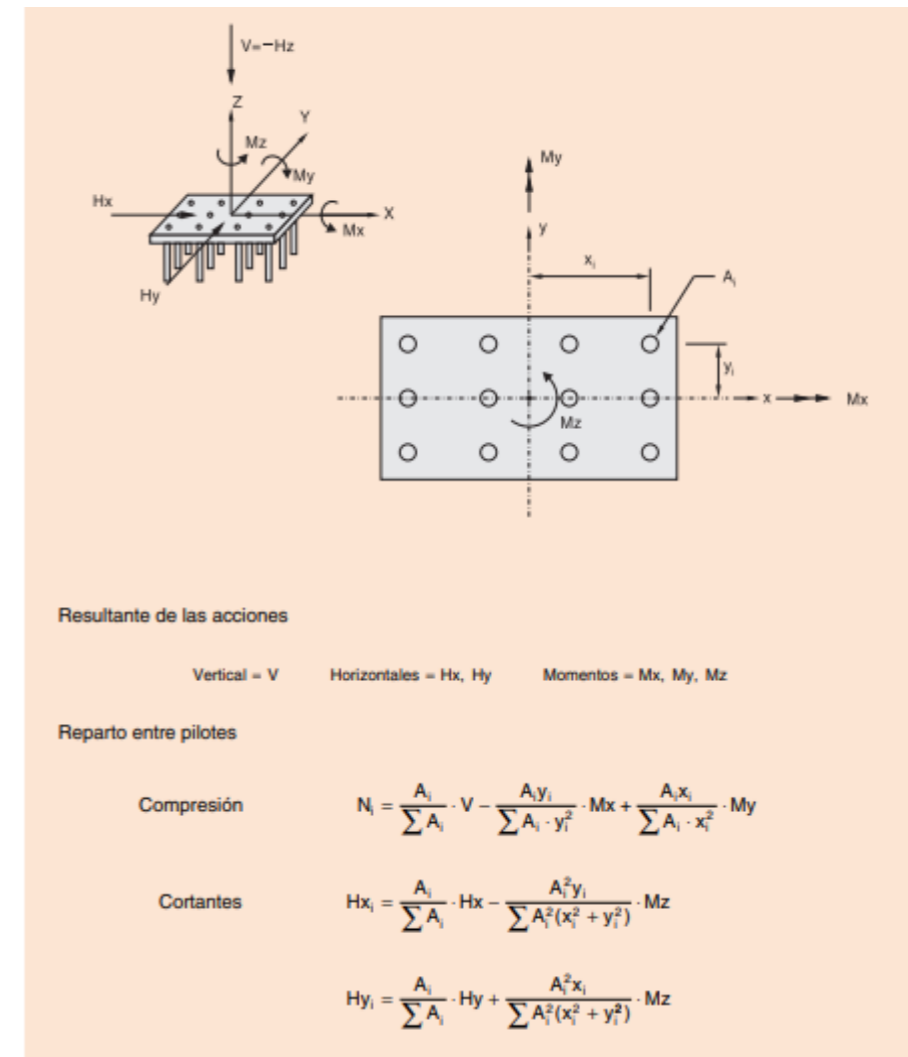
DISTRIBUCIÓN DE CARGAS EN LA HIPÓTESIS DE ENCEPADO RÍGIDO Y PILOTES ARTICULADOS EN CABEZA
